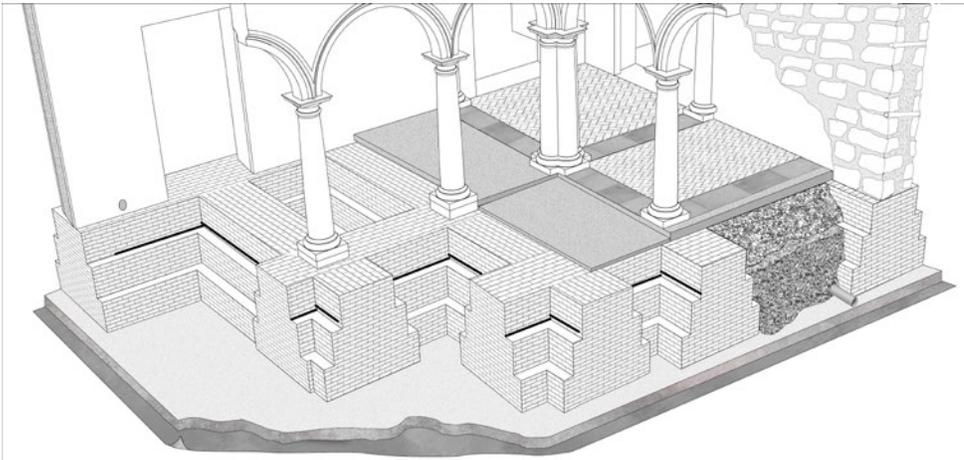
Propuesta de consolidación estructural de la cimentación superficial mediante “*sottomurazione*” en ladrillo. Fuente: autores, 2017.
